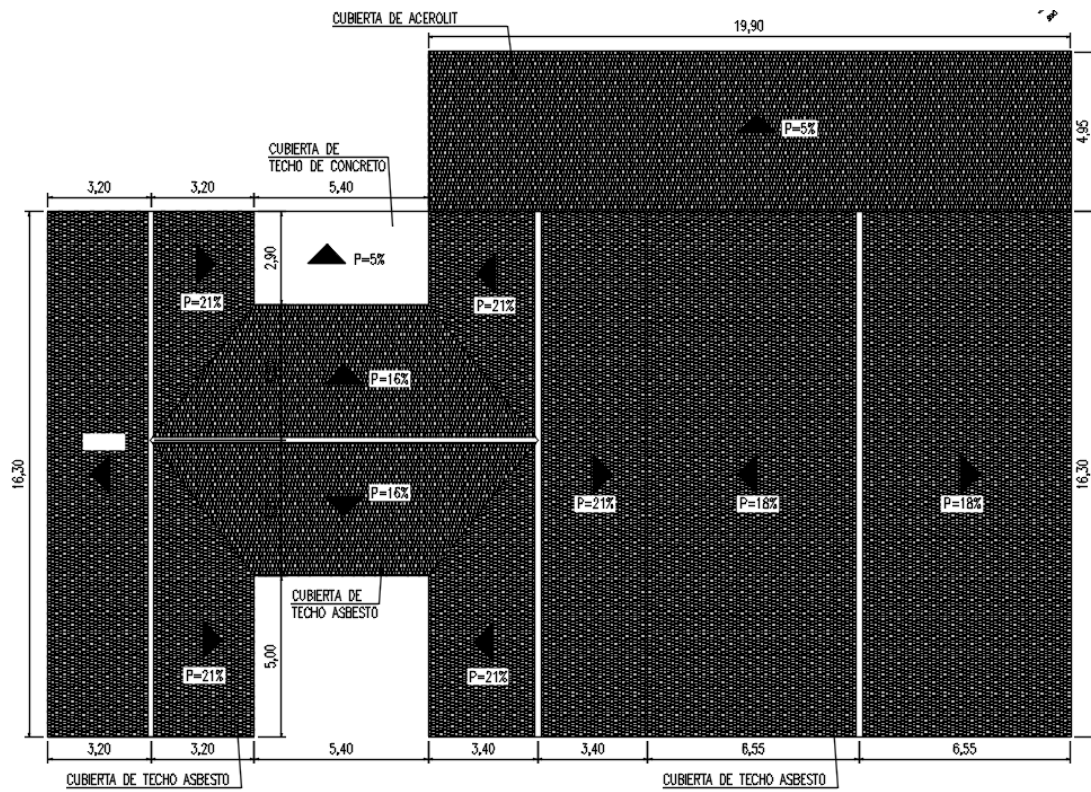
Levantamiento de la planta techo del ala izquierda del EN7.
